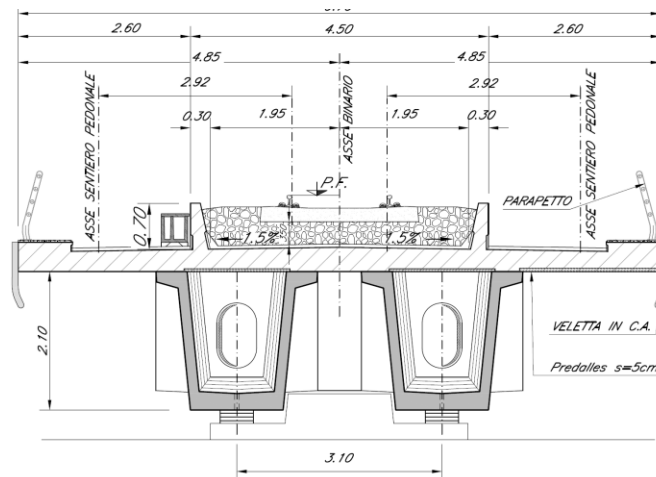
Sezione trasversale campate in c.a.p. L=25 m
